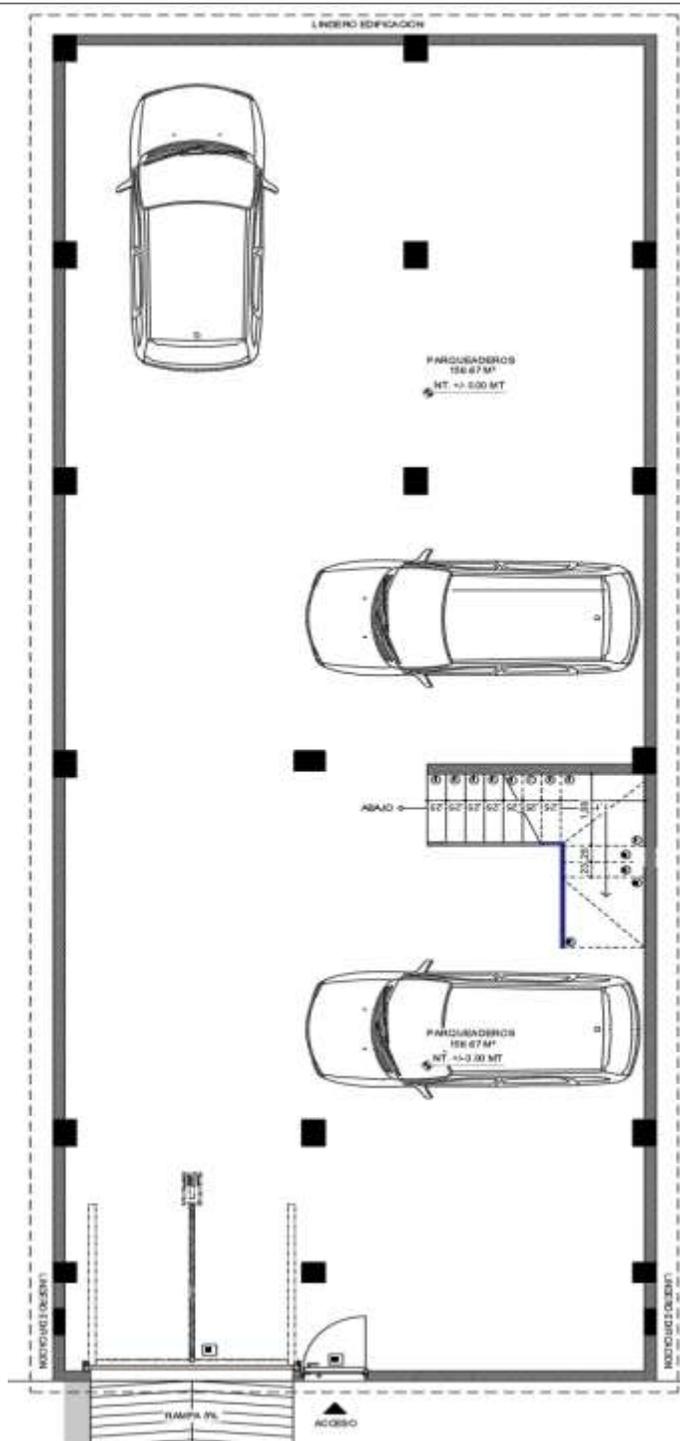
Plano arquitectónico nivel parqueadero. Adoptado de: Reconstrucciones
